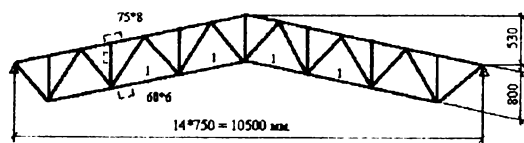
Схема расчетных стержней фермы, 1 – расчетные стержни фермы
